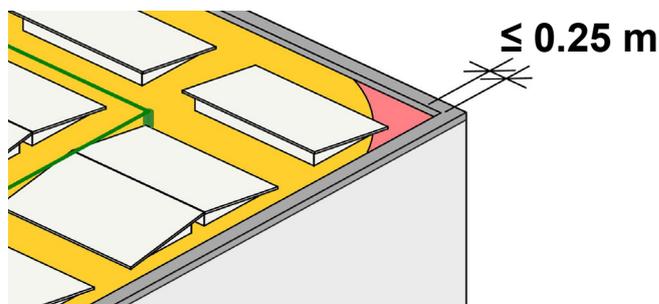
max. 0,25 m di distanza dal lato dell'impianto solare (per impedire l'accesso involontario) se ogni modulo ha una via di circolazione e tutti i lati sono accessibili per l'ispezione (impianto solare e tetto piano)
